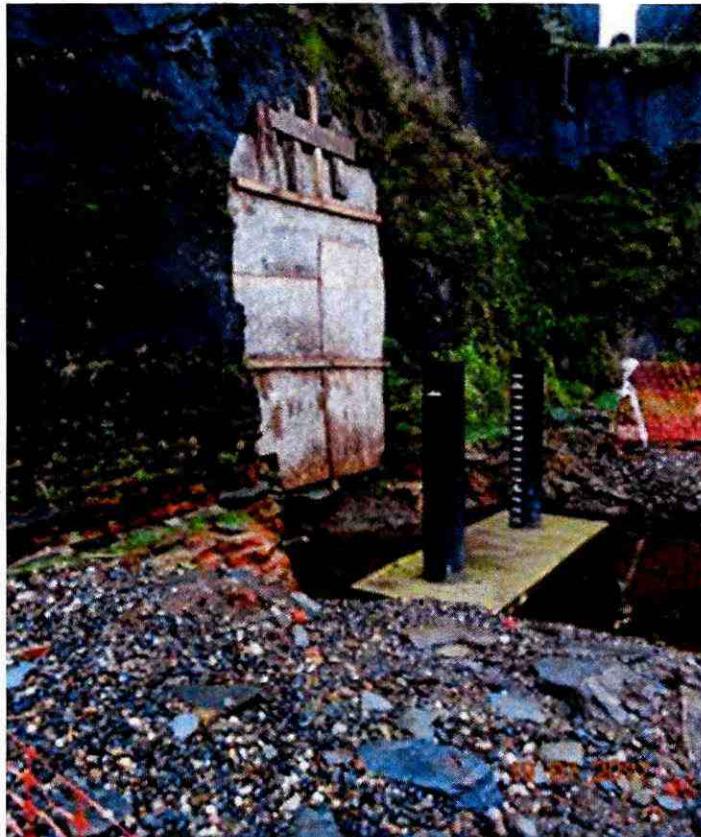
Playa La Argolla, pilotes instalados a 1,5. Metros de la entrada del túnel, zona de intervención¹
